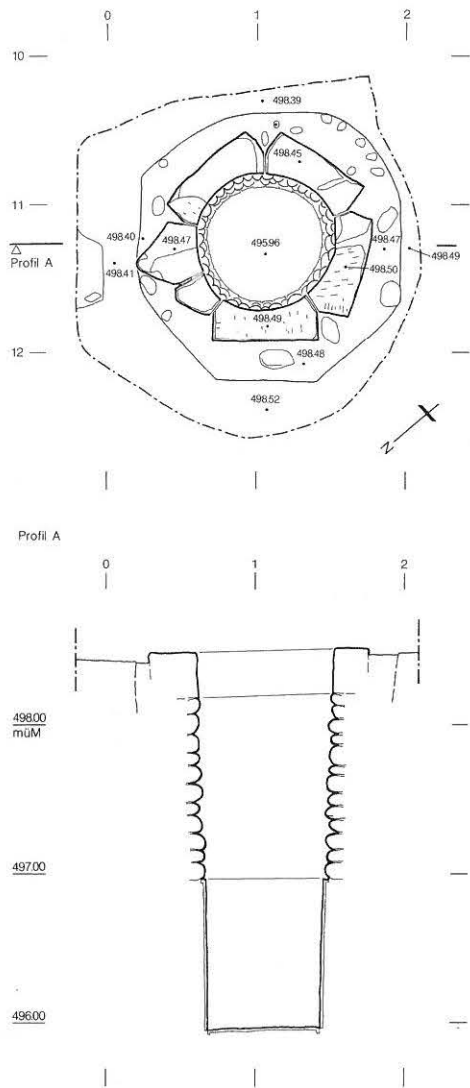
Zauggenried, Parz. 213. Sodbrunnen. Grundriss und Schnitt. M. 1:50.
